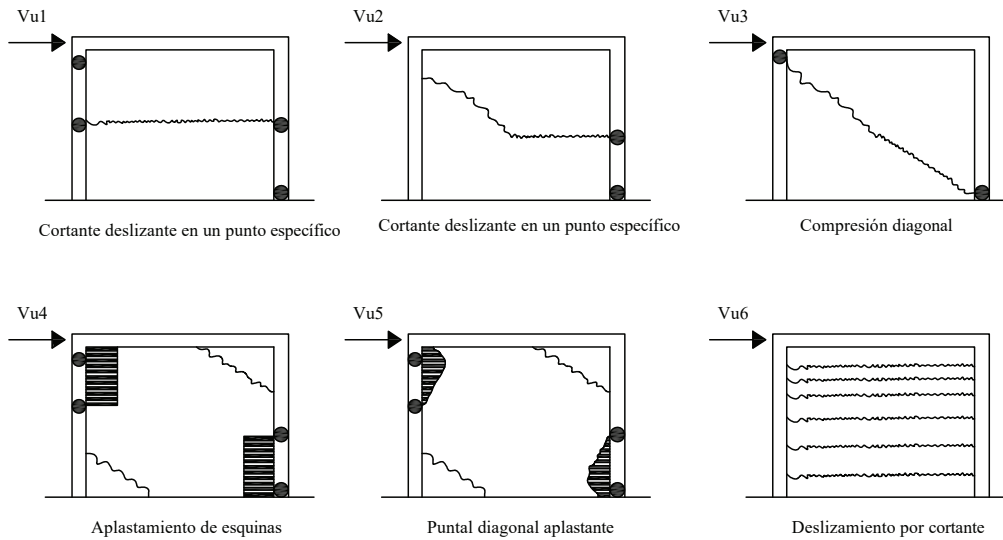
Tipos de fallas que se presentan en la mampostería, Shing y Mehrabi,2002
